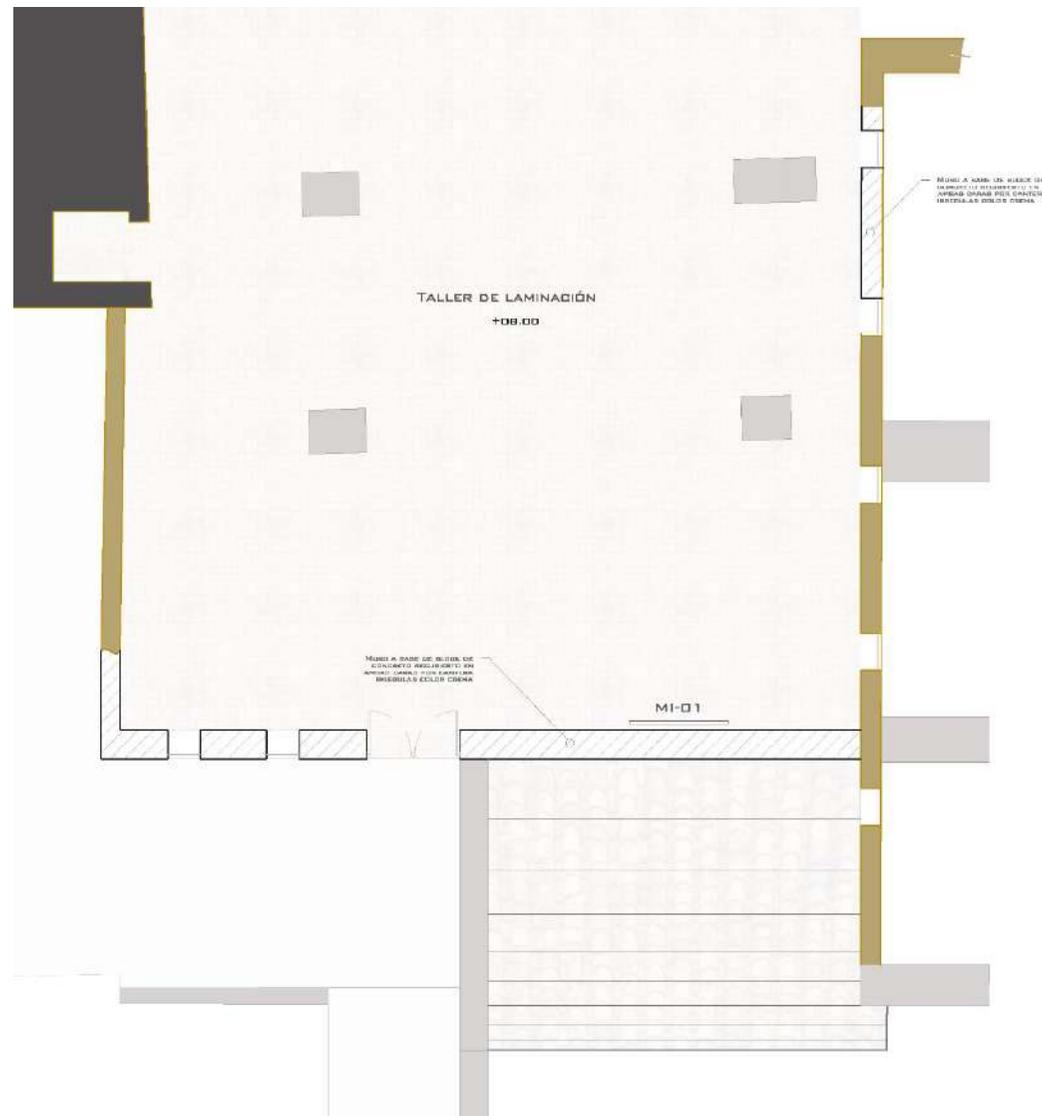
Planta alta de zona de protección, en amarillo y gris se marcan los muros originales.
